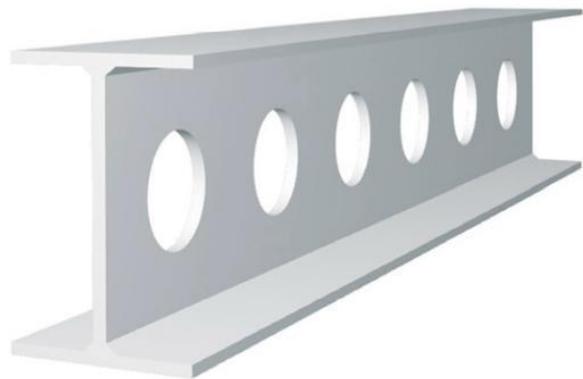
photo d'une poutre métallique alvéolaire/Source : <http://Google image.com>
